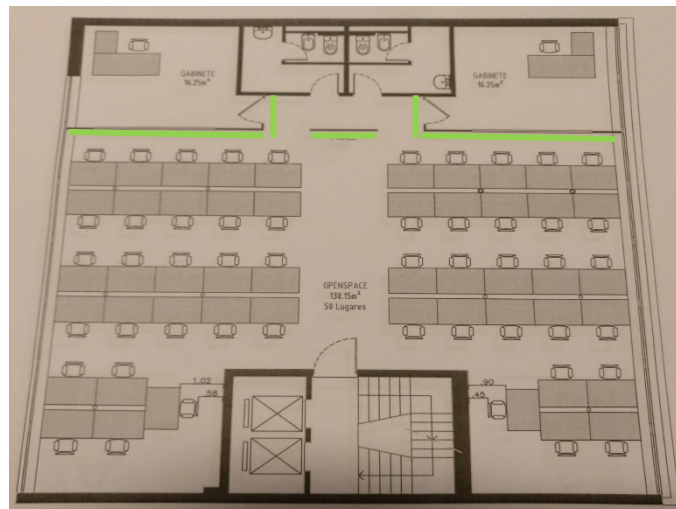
Planta Tipo, após intervenção, com divisórias a efetuar dos Pisos 2 ao 4.
